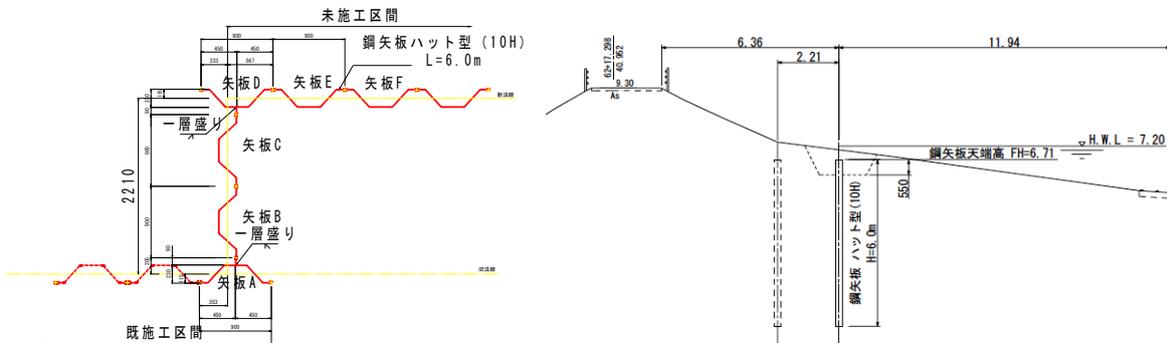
遮水矢板工法線変更における詳細図(左)及び横断面図(右)
